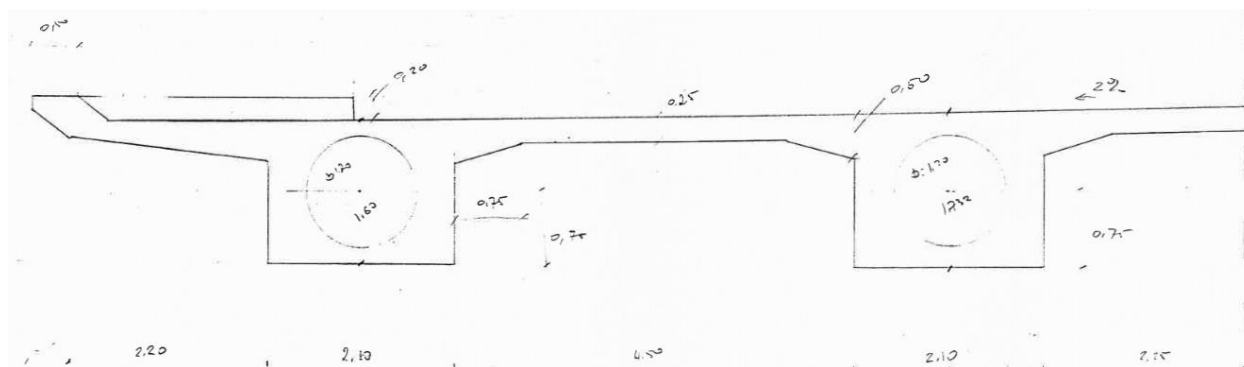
Sección tipo del tablero viario. Fuente: Ayto. de Sevilla. Gerencia de Urbanismo.
